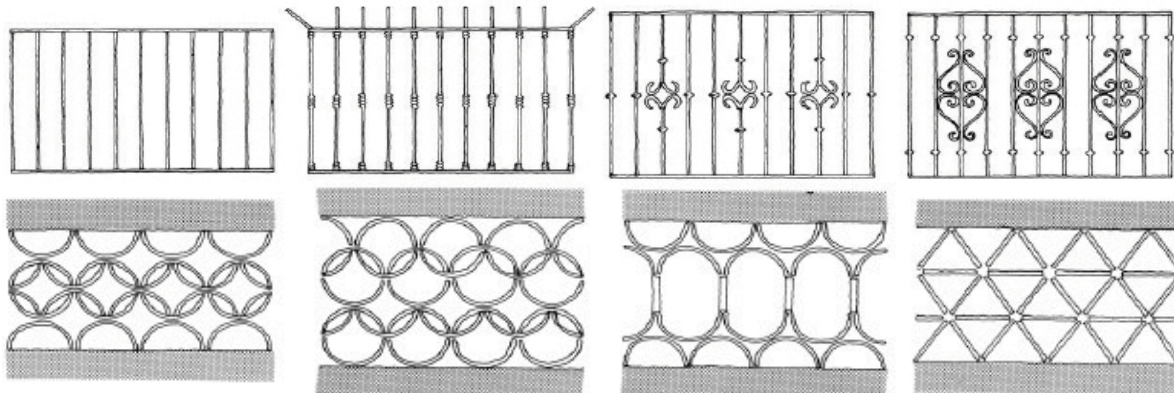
Ejemplo de elementos arquitectónicos recurrentes en Taxco: citarillas y barandales.
